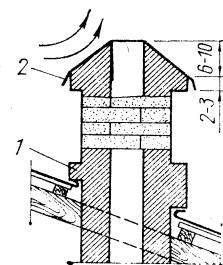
Противоопрокидывающий оголовок трубы в форме пирамиды: 1 — разделка у крыши; 2 — металлическая облицовка
